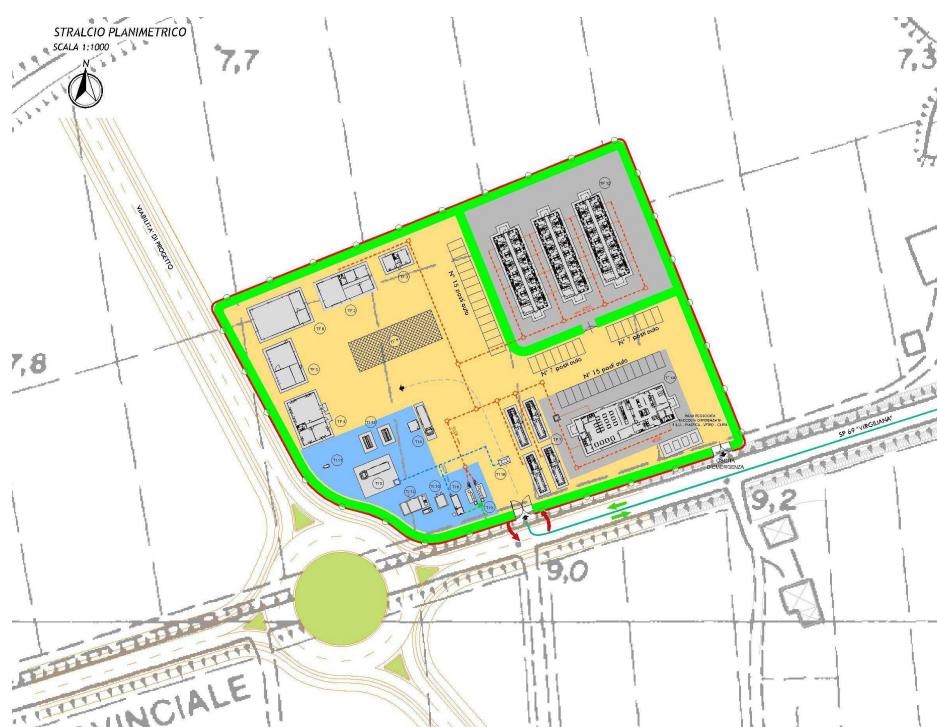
LAYOUT AREA DI CANTIERE CAMPO BASE 1FE2-B
